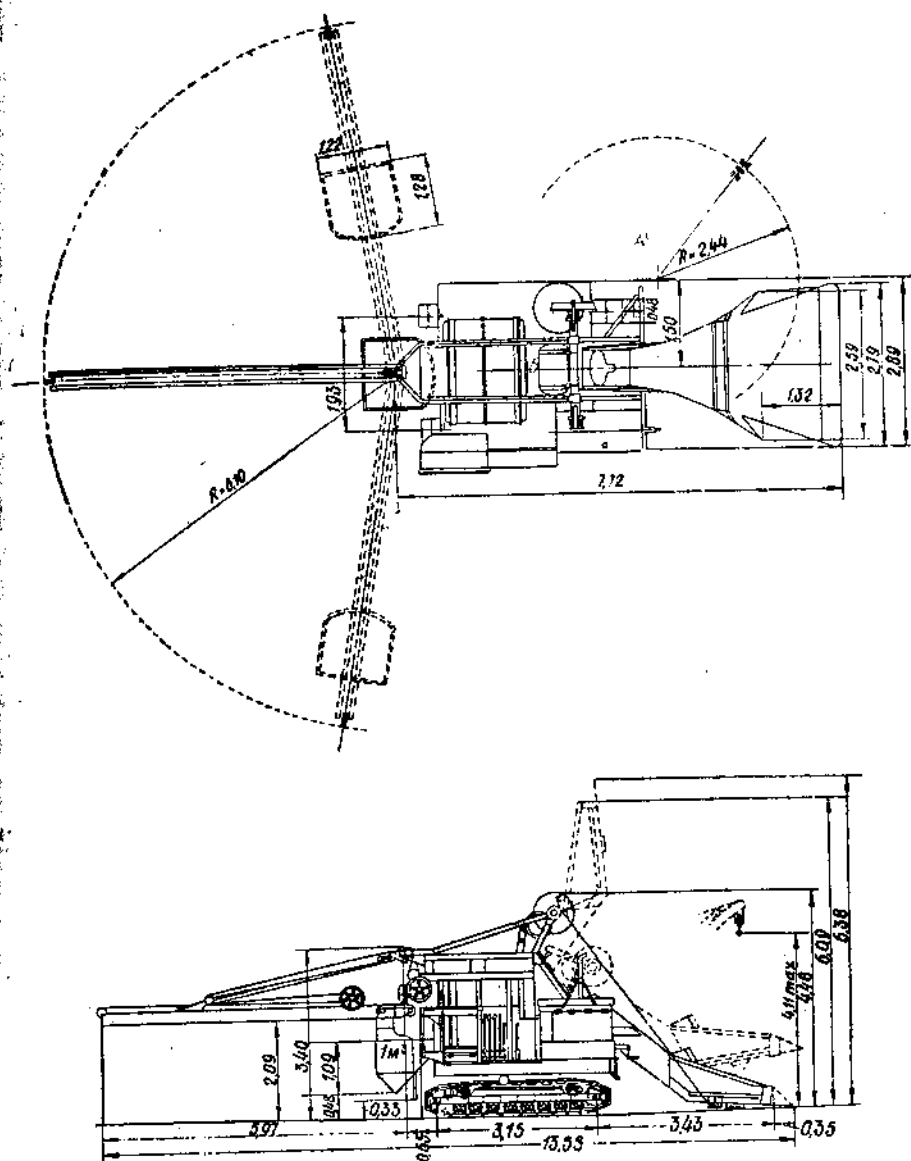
Схема дорожной бетономешалки 27Е „Рекс-Пэйвер“.
